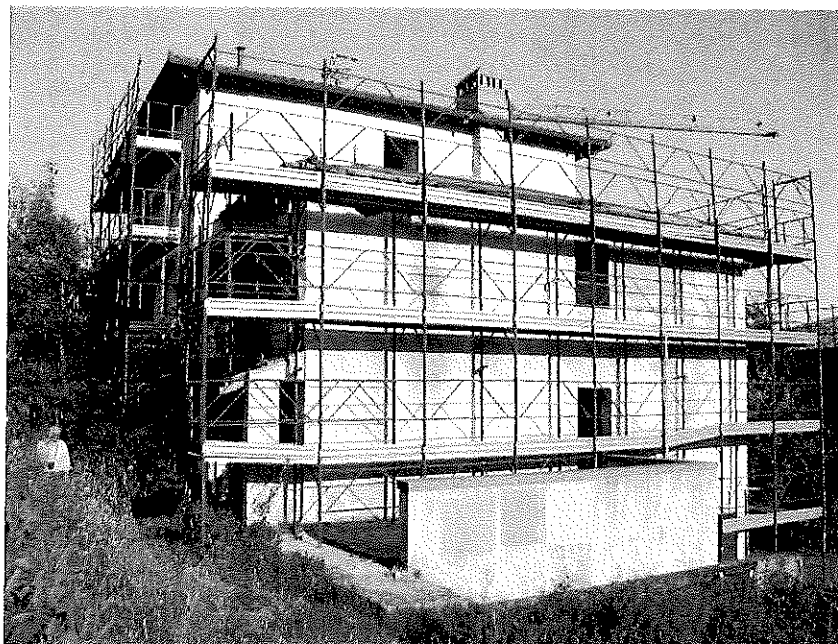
Vista d'insieme del fabbricato "A" dalla corte esterna lato ovest
